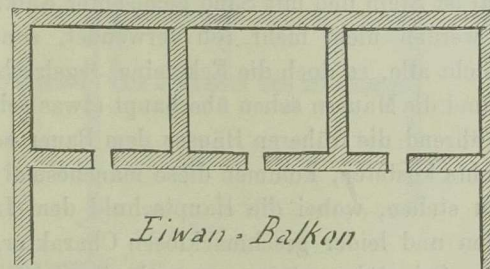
Grundriss des ersten Stockwerkes eines Hauses aus dem Bezirke Choturdschu.
